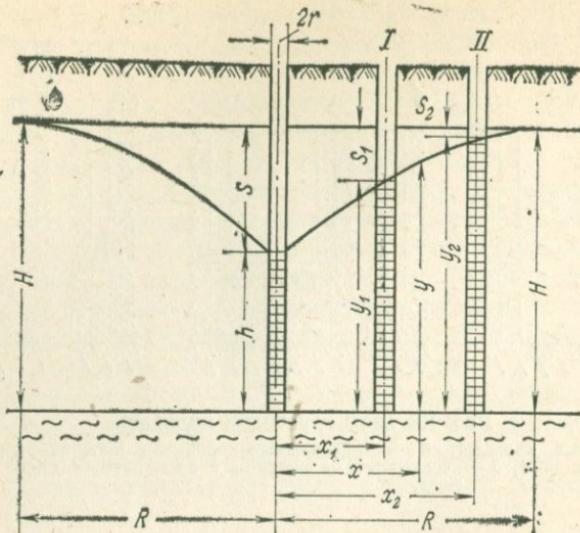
Расчетная схема для определения дебита грунтового колодца
